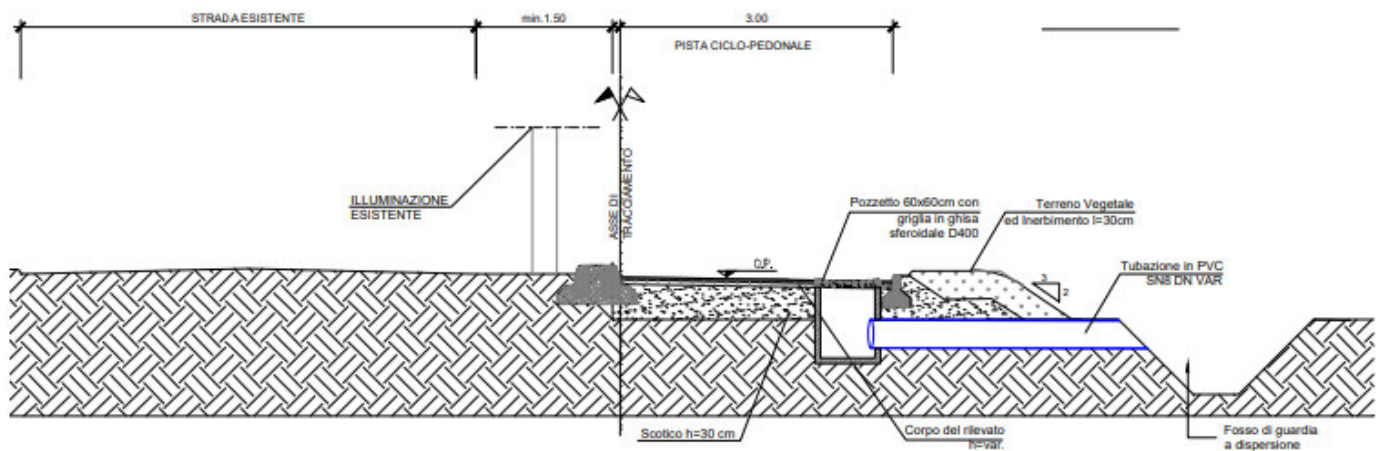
sezione tipo della pista ciclopedonale in rilevato
